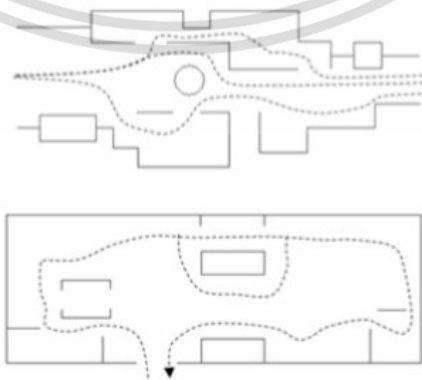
การจัดระบบสัญจรแบบ Room to Room Arrangement
